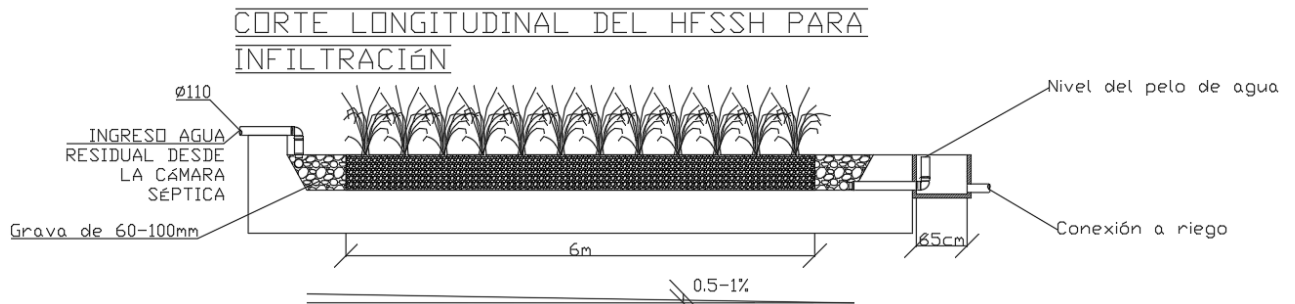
NOTA: PLANO DEL HFSSH PARA INFILTRACIÓN. ELABORACIÓN PROPIA
